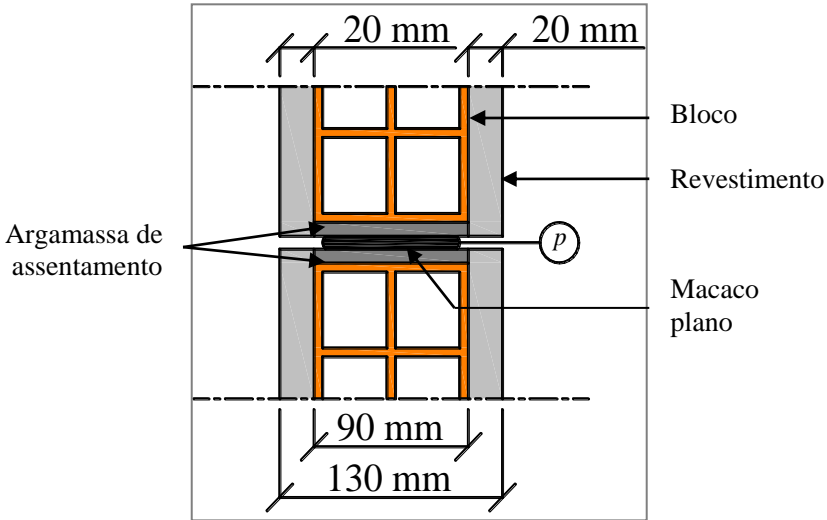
Ensaio A: corte transversal da parede com revestimento e a inserção do macaco plano
